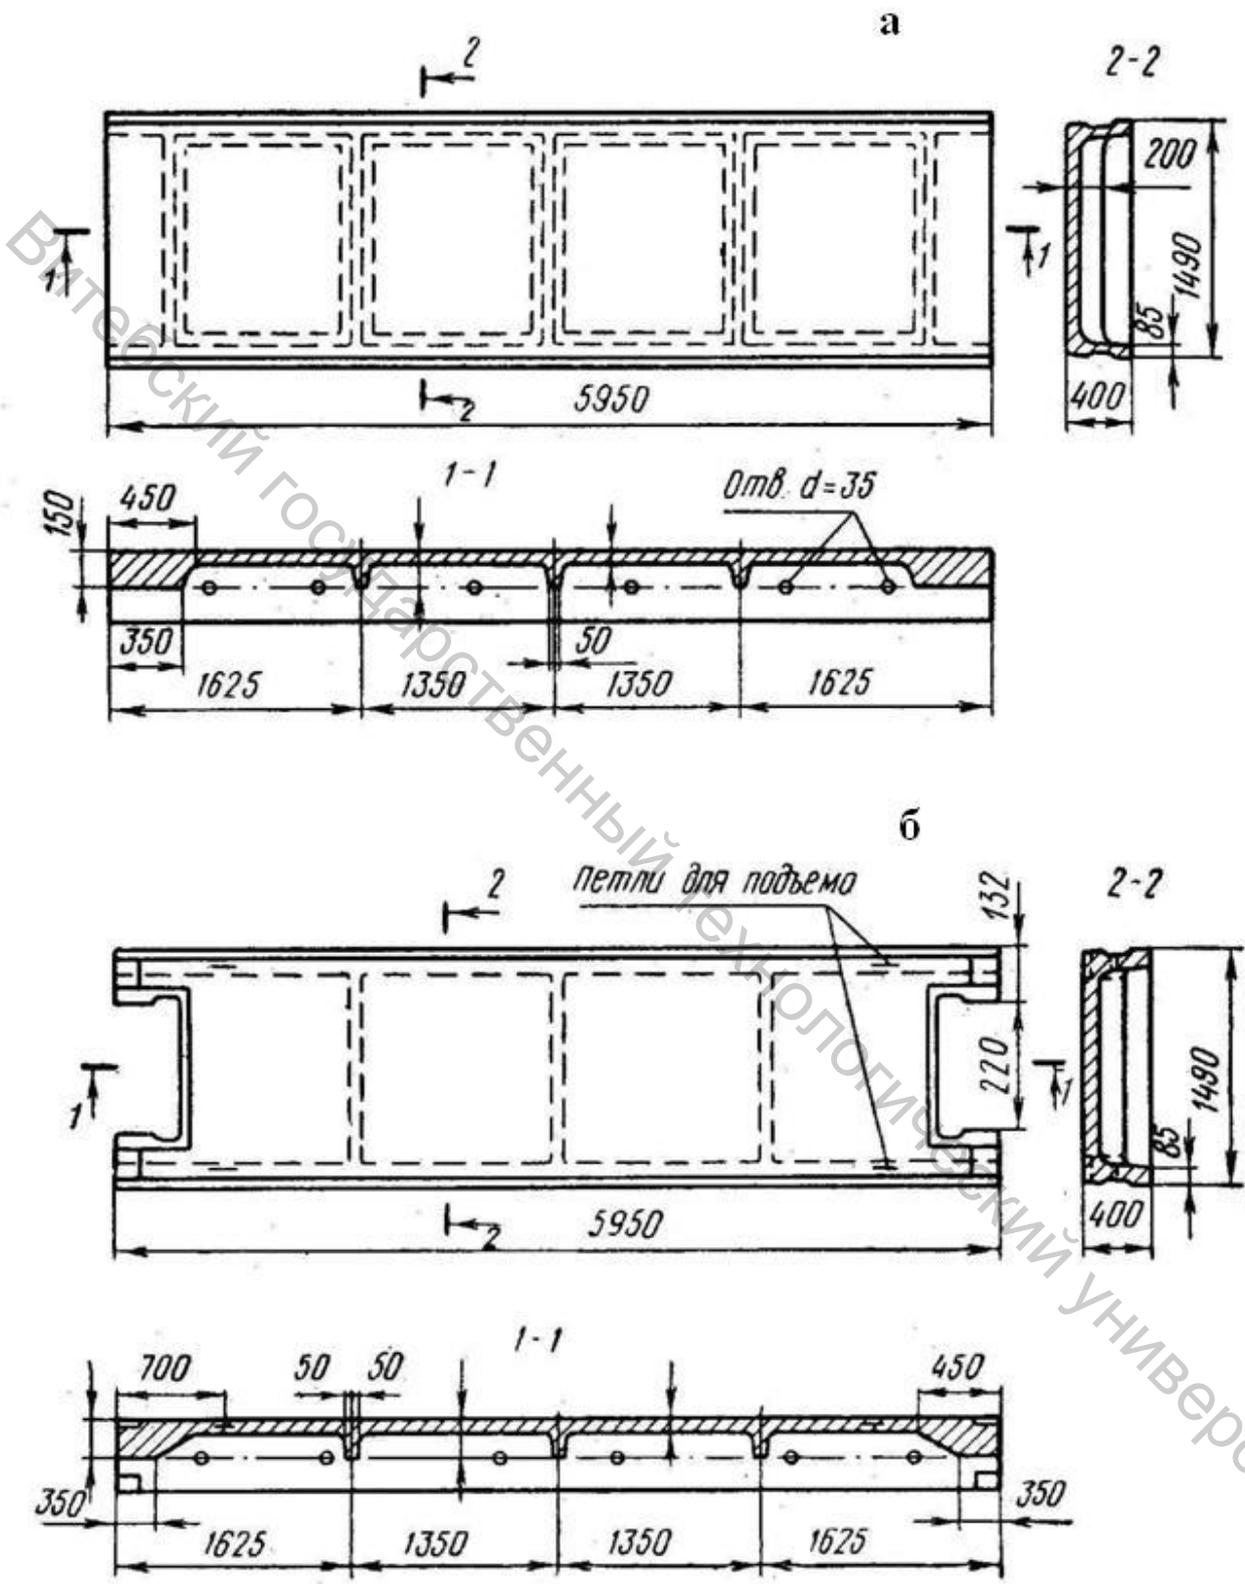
Типовые железобетонные плиты междуэтажных перекрытий производственных зданий: а – рядовая, б – межколонная
